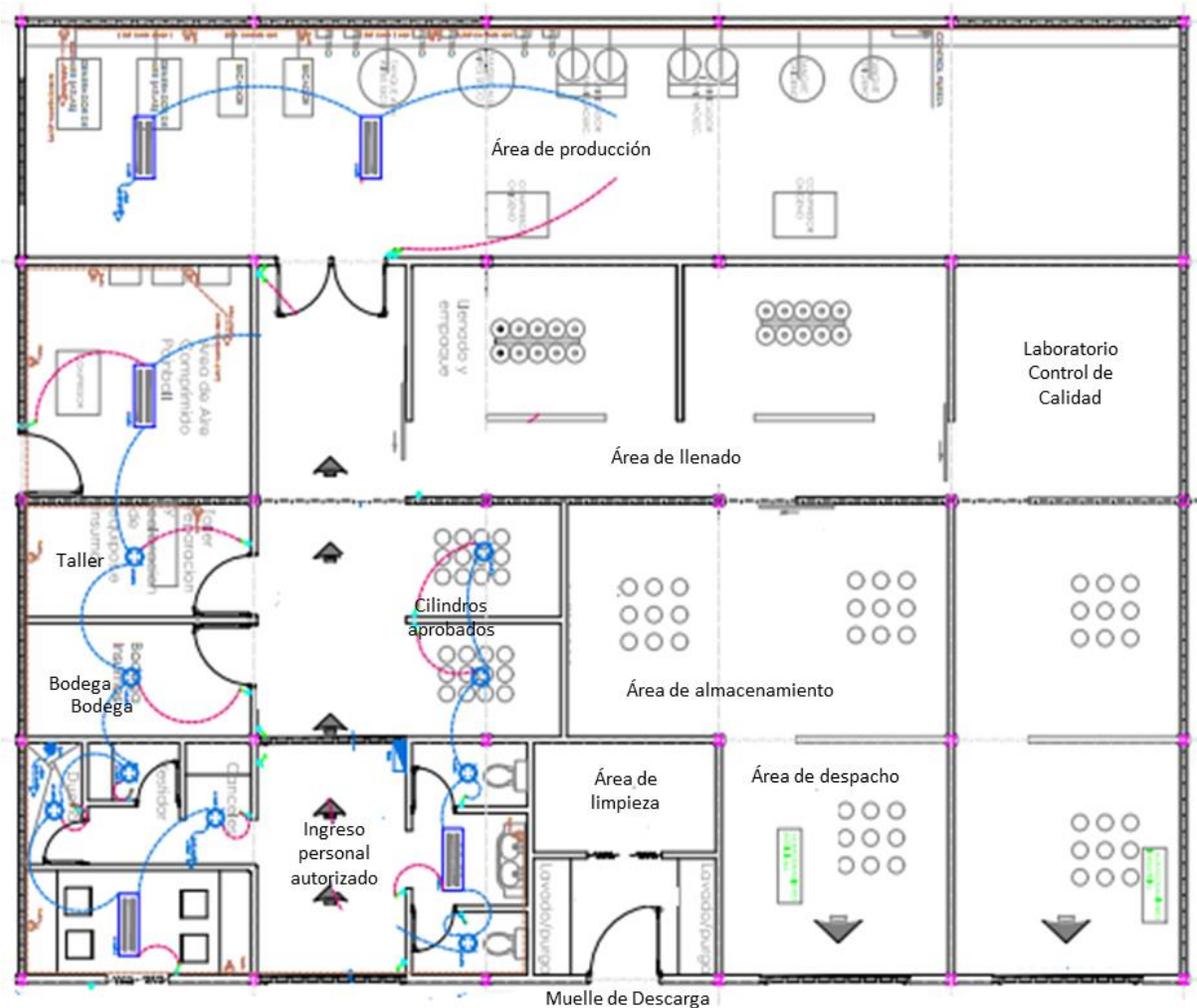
Plano de la Planta Oxiovest Cia. Ltda.
